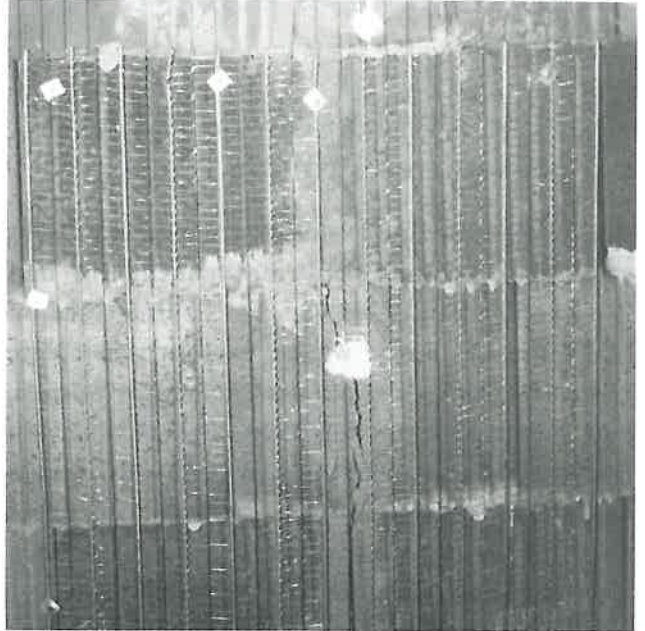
Risse im Außenmauerwerk über Randbalken (Pos. 41, Abb. 2), mit Ziegeldraht vor dem Putzen überspannt
